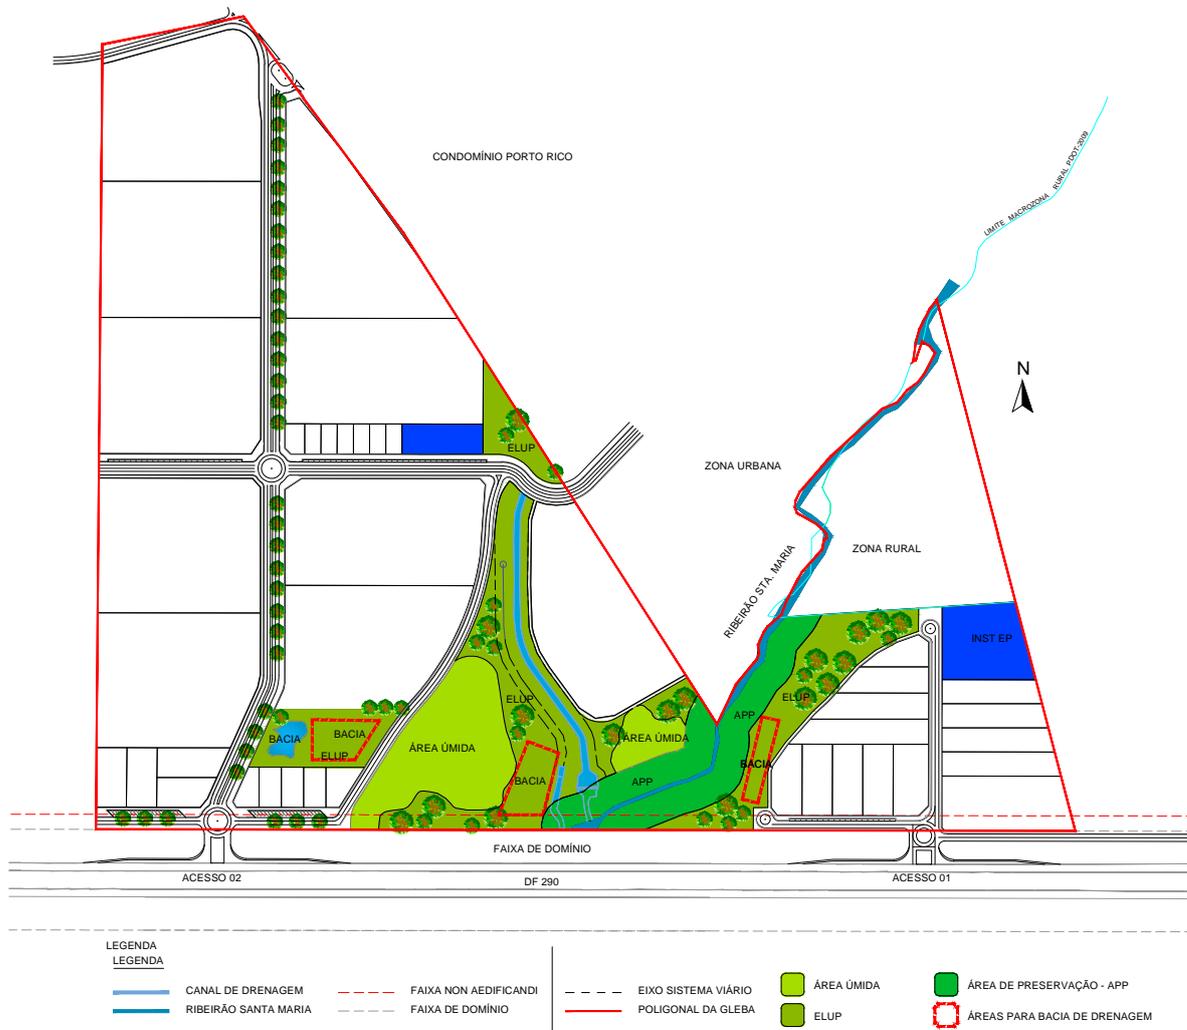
Croqui indicativo da bacia de amortecimento para águas pluviais.
